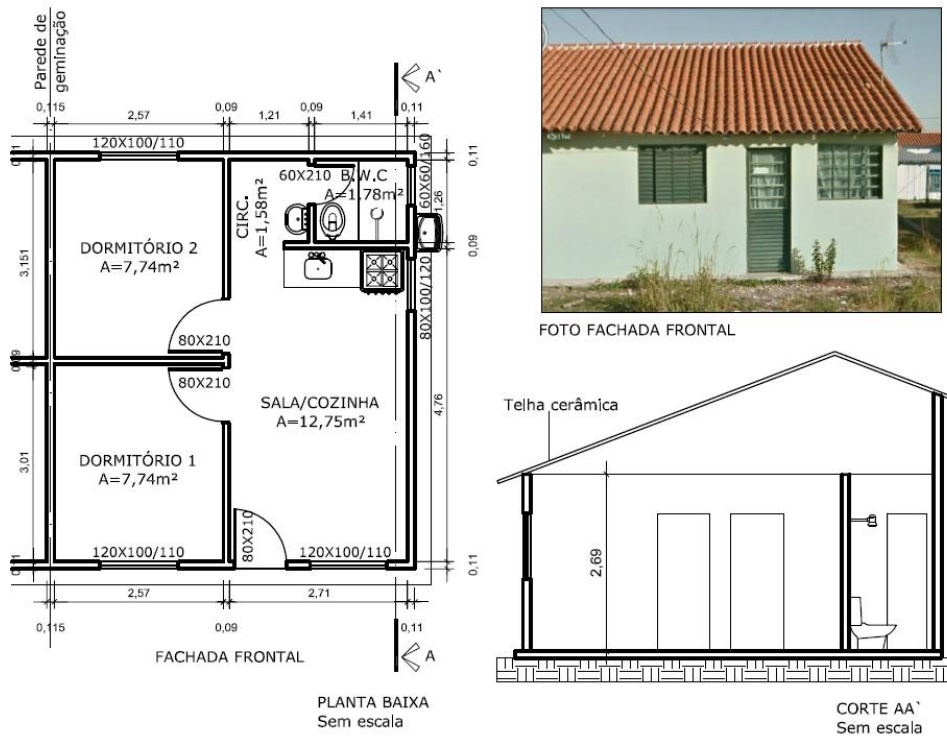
Planta baixa, corte e foto da fachada frontal da habitação-tipo do Residencial Cipriano da Rocha
